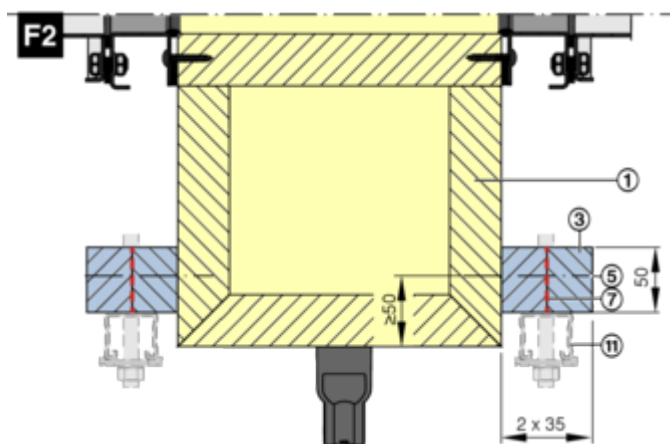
Einbaudetail F2: Abhängung Antriebskasten Deckel (Bestellmerkmal S)
